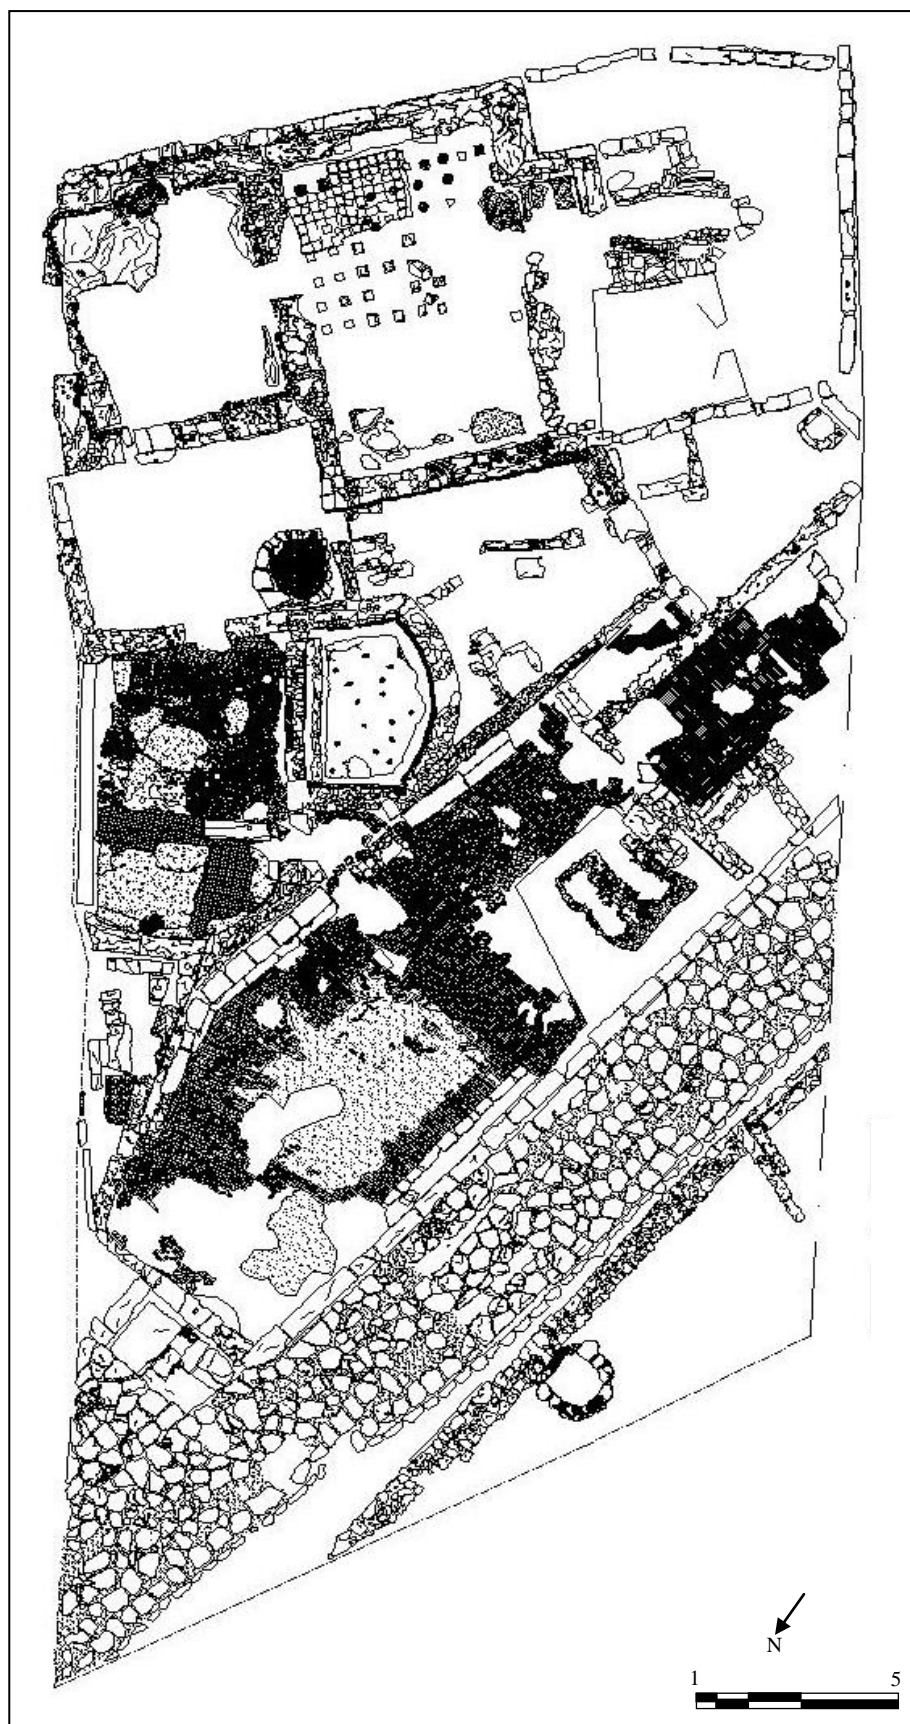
Planimetria relativa a quota 0 (gentilmente concessa dalla Prof.ssa Cassano)
